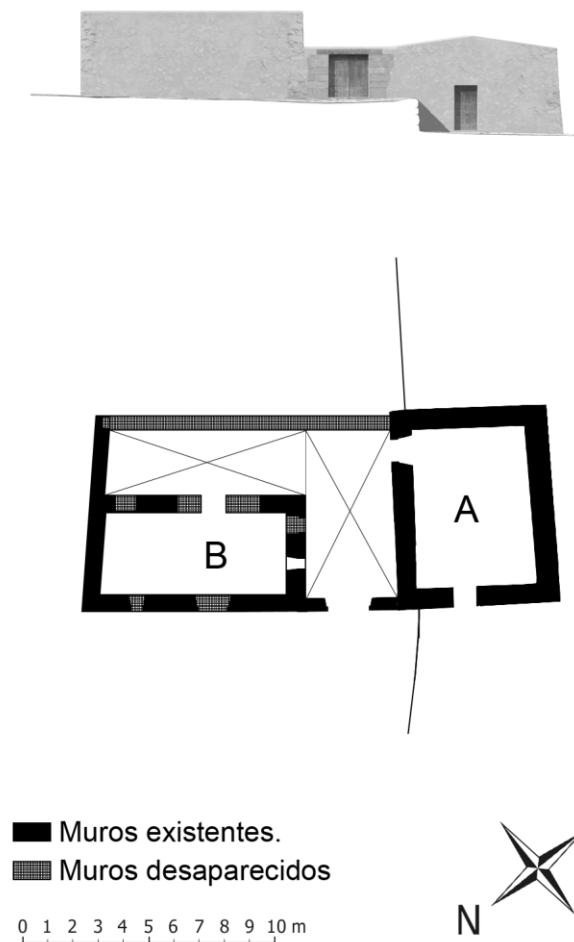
Planta y alzado de las estructuras conservadas del cuerpo A, Fase 1, anterior al s. XIII.
